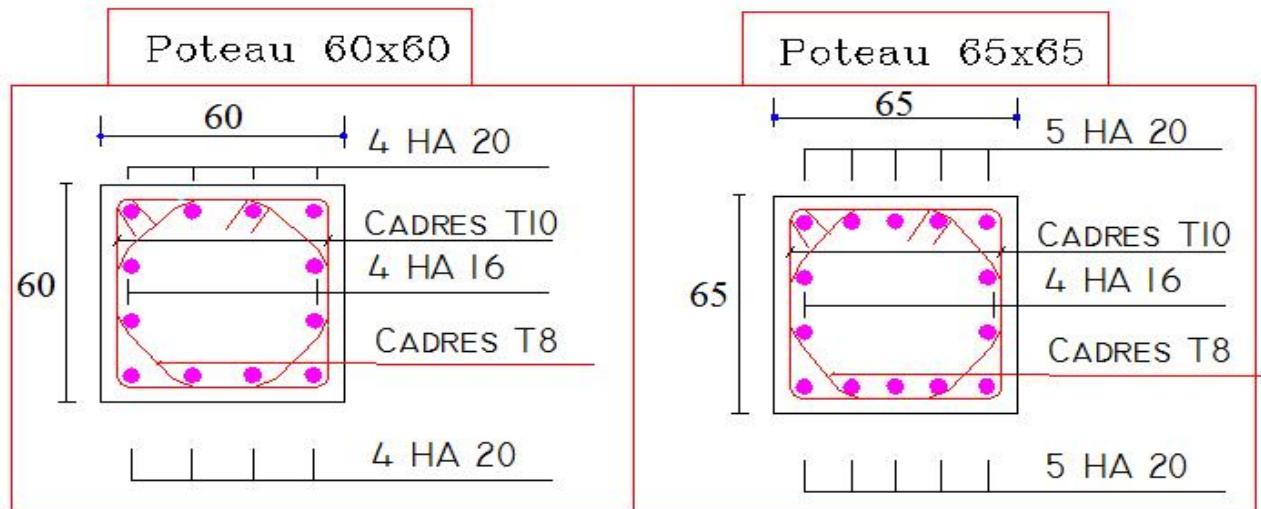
Schéma de ferrailage des Poteaux carrés.
